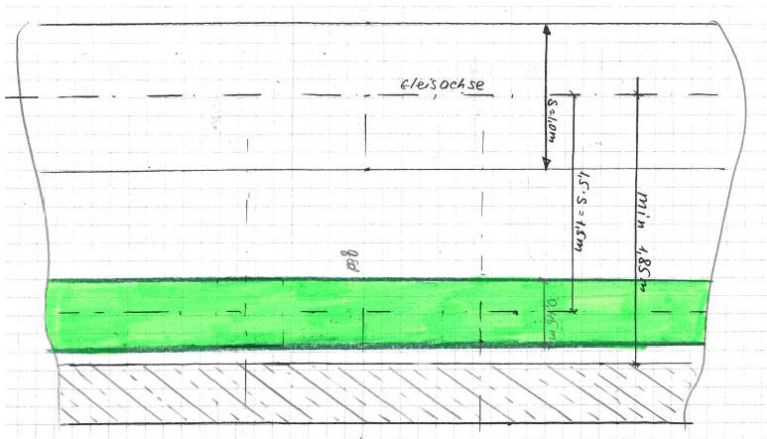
Entgleisungslastmodell 2 (Grundriss)
